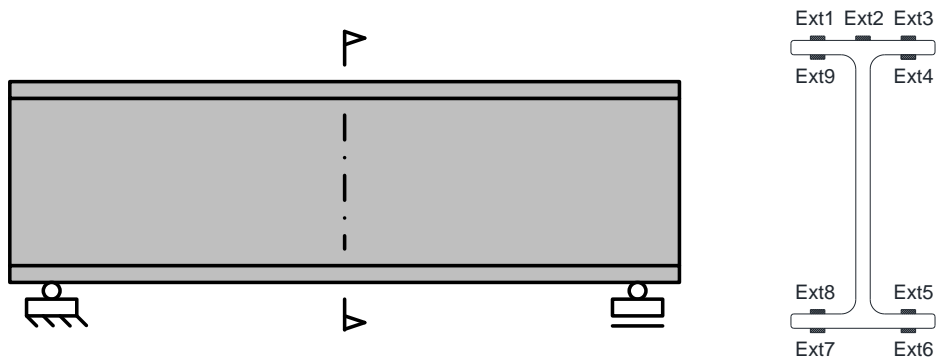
Colocação de extensómetros na secção de meio-vão da viga
